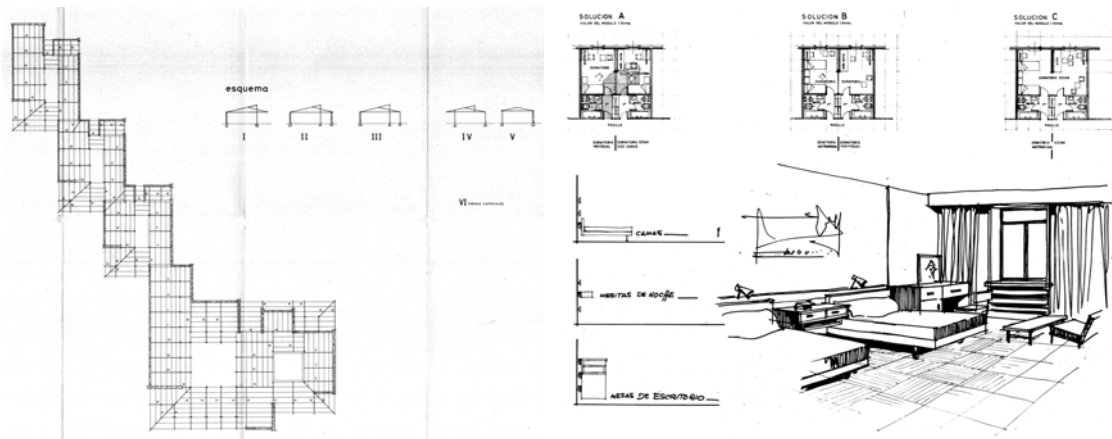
(a) Plano de estructura. (b) Disposición de muebles.
